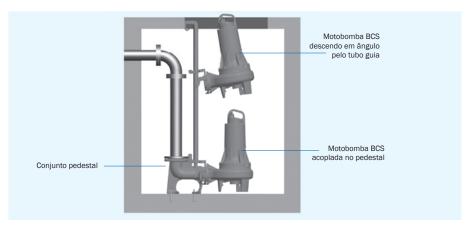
Esquema de instalação da motobomba com sistema de acoplamento direto no pedestal.
